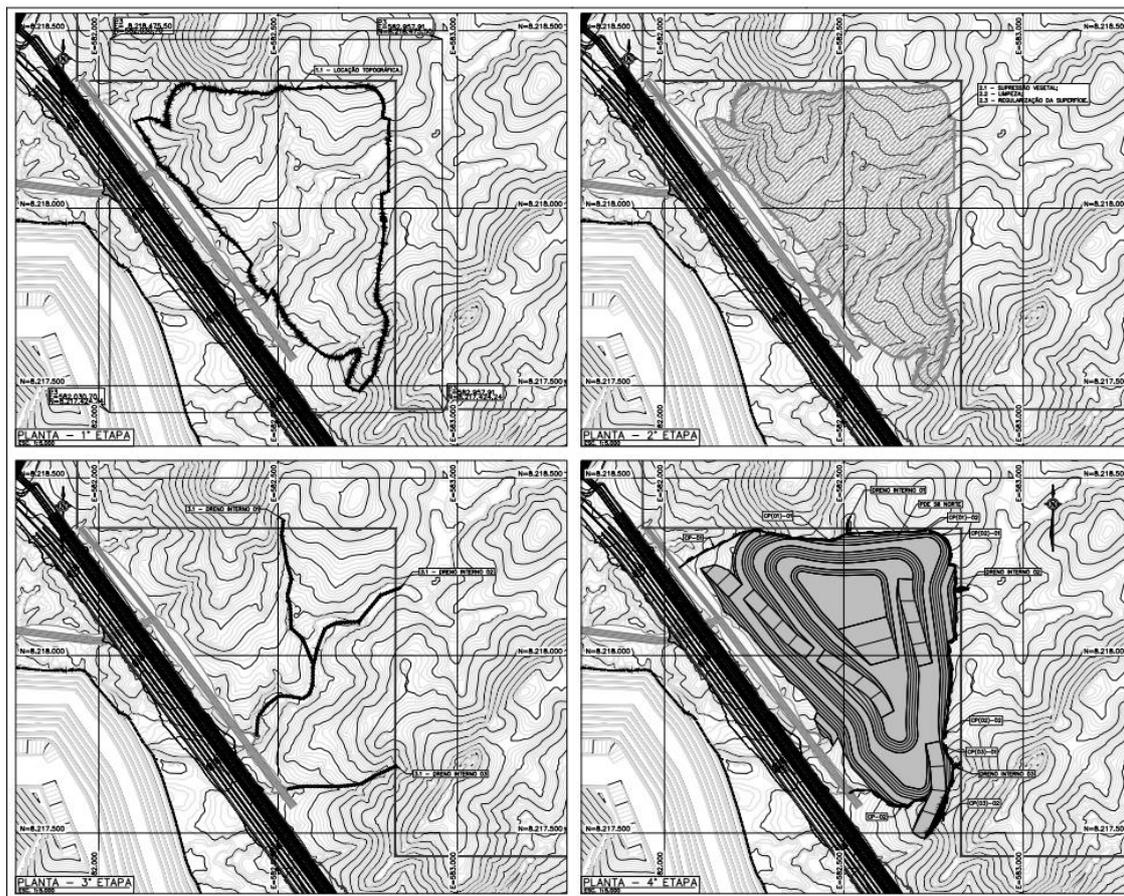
Faseamento construtivo da Pilha de Estéril S6 Norte
